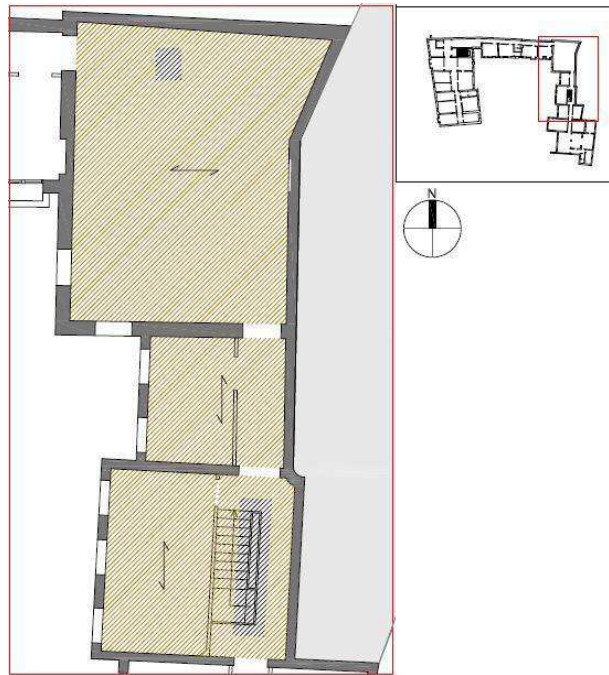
Secondo orizzontamento rilievo strutturale
